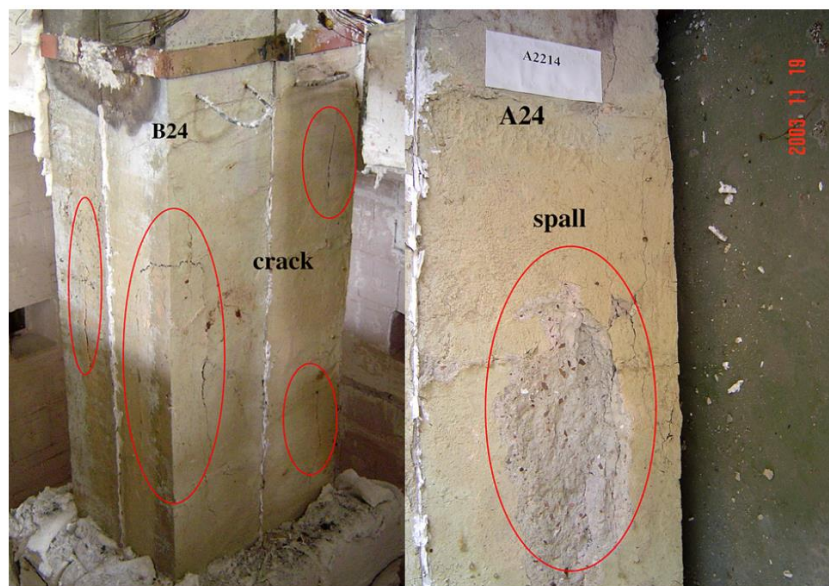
Fisuración y descascaramiento en columnas luego de ensayos de incendio (Jau y Wang, [6])
